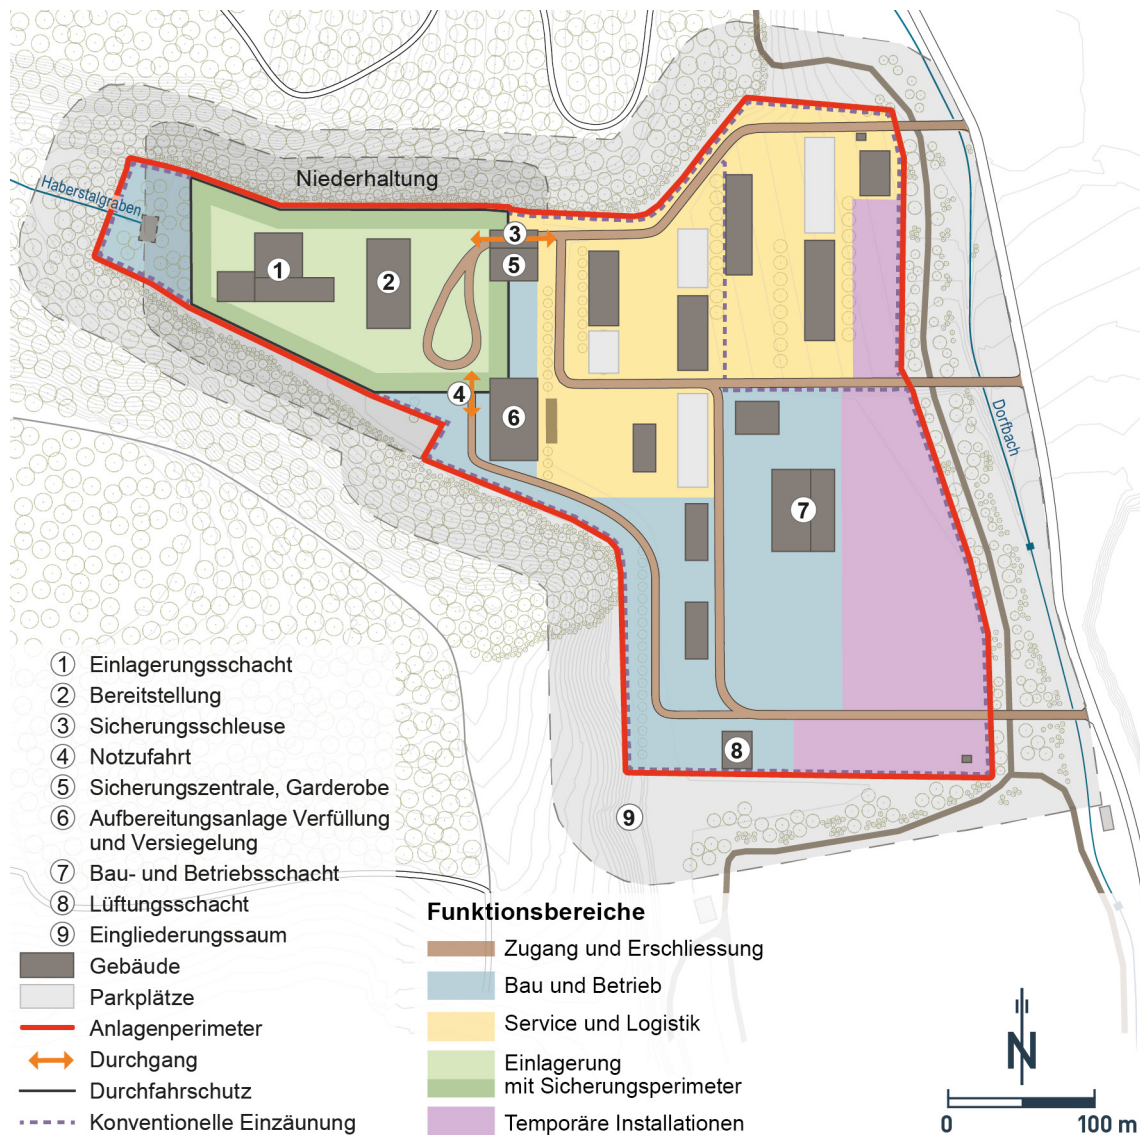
Anlagenperimeter mit Bauten und Eingliederungssaum
